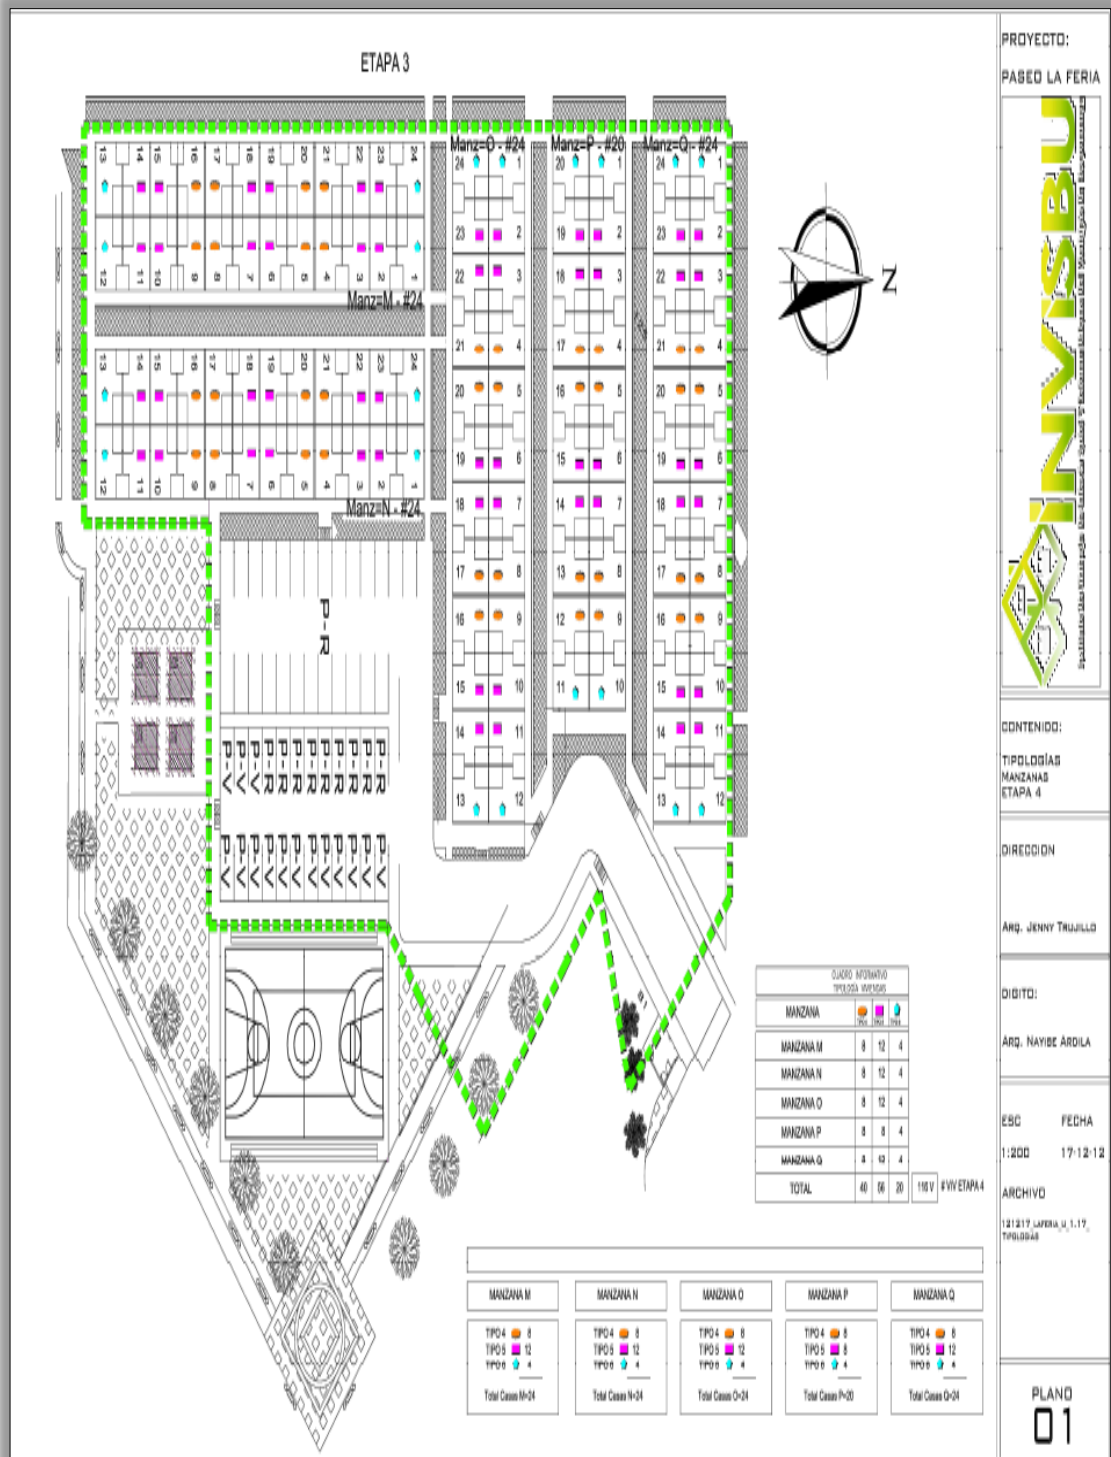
Plano tipologías manzanas etapa 4: vivienda tipo seleccionada[20]
